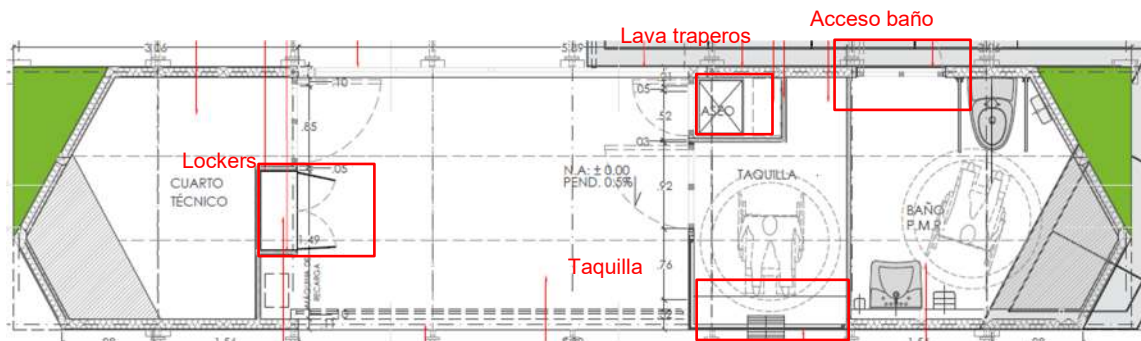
Corte en Planta Taquilla con ajuste taquillera, baño y lava traperos. Plano 6. A-101 PLANTA 1ER PISO-CUBIERTA.dwg
